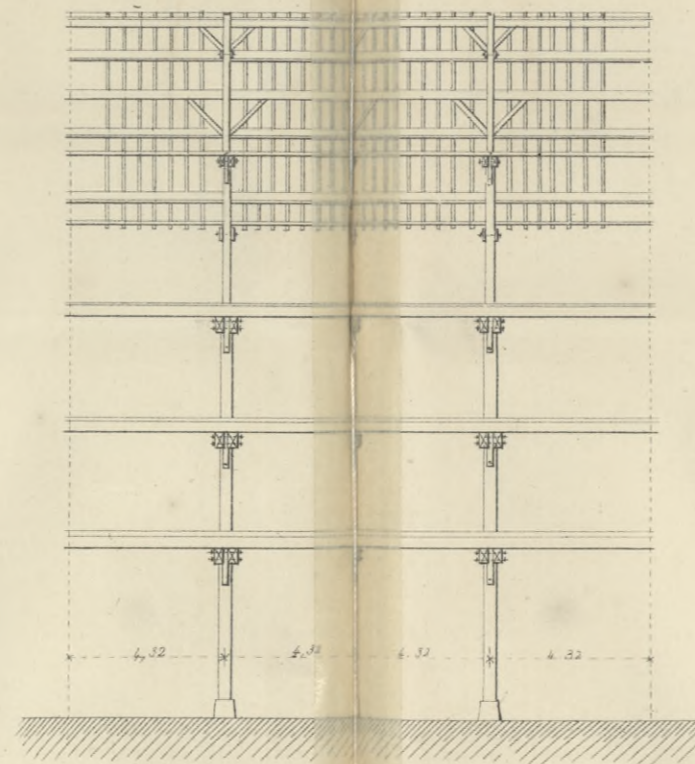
Elevation d'un Pignon à 0^m005 pour 1^m.
